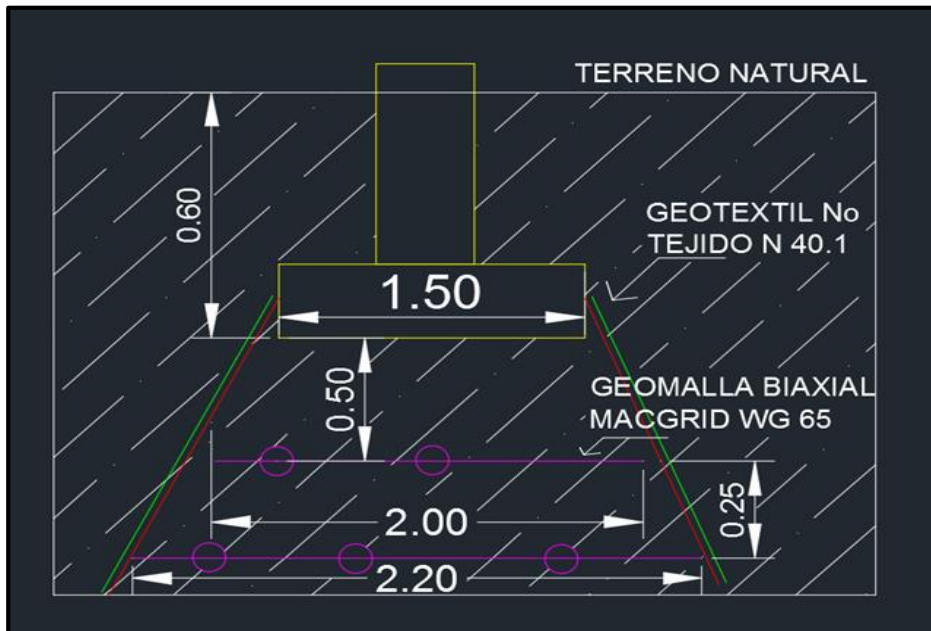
Diseño de cimentación con refuerzo de geomallas para zapata N°1
